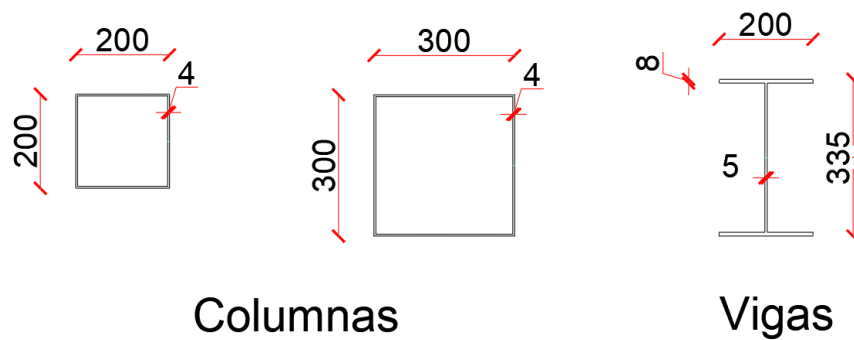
19: Secciones de las vigas y columnas del sistema estructural
